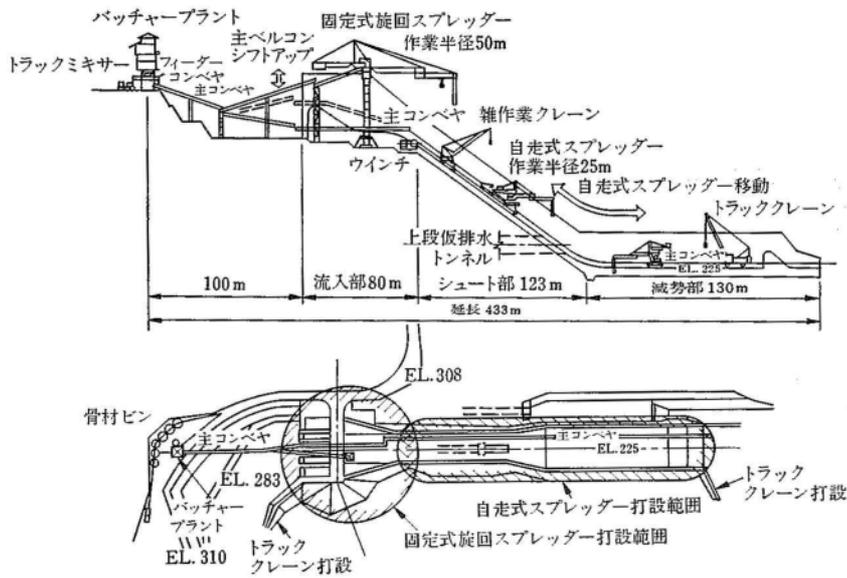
3 - 13 フィルダム洪水吐コンクリート打設 BCP 工法 (七ヶ宿ダム)
